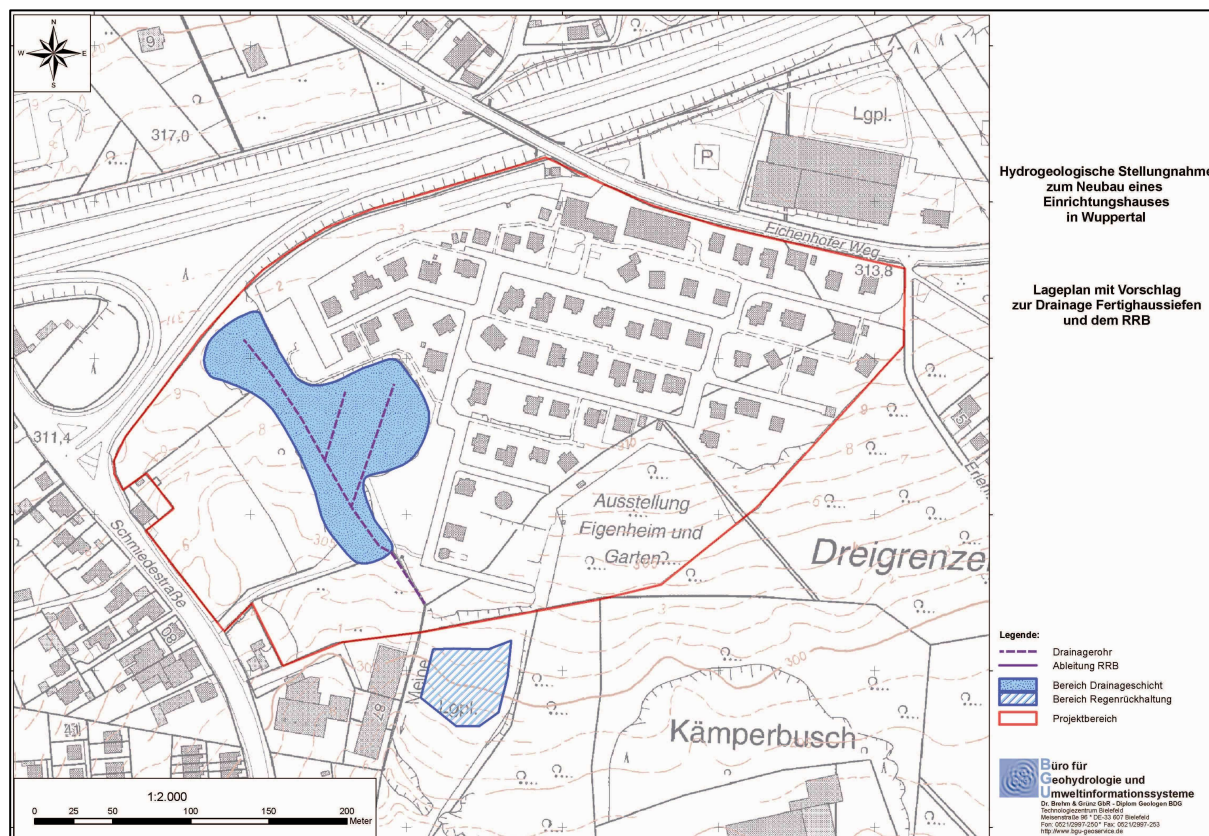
Lageplan mit Vorschlag zur Drainage des Teilbereichs A, Quelle: Hydrologisches Gutachten [1].
